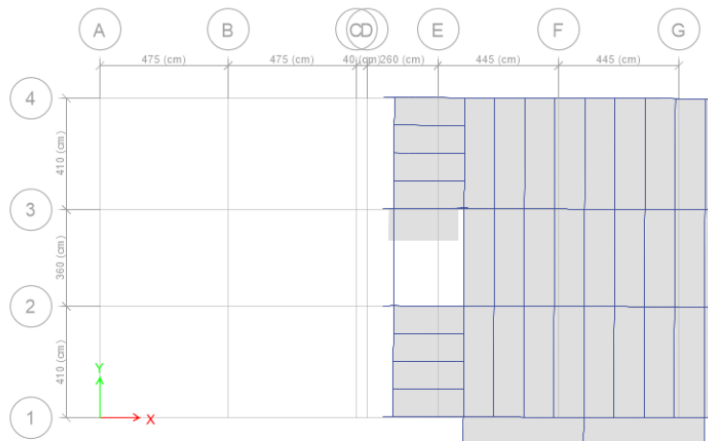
Zona B-Vista en planta primer modo de vibración. Traslación en x (ETABS).
